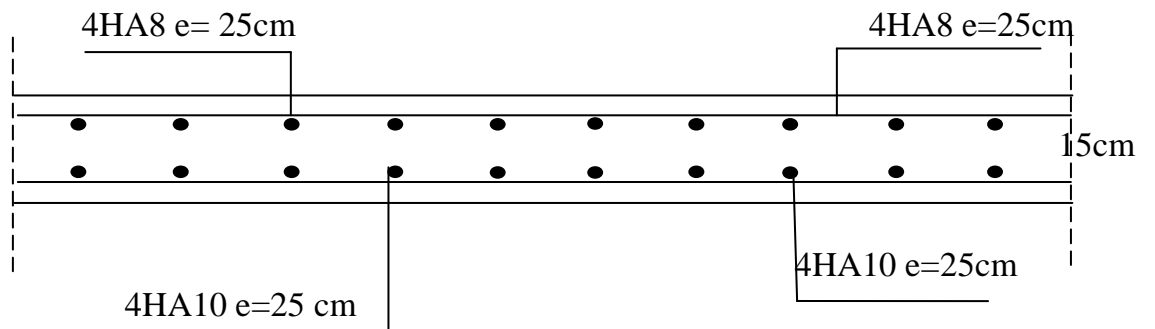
Plan de ferrailage de la salle machine suivant : x-x et y-y.
